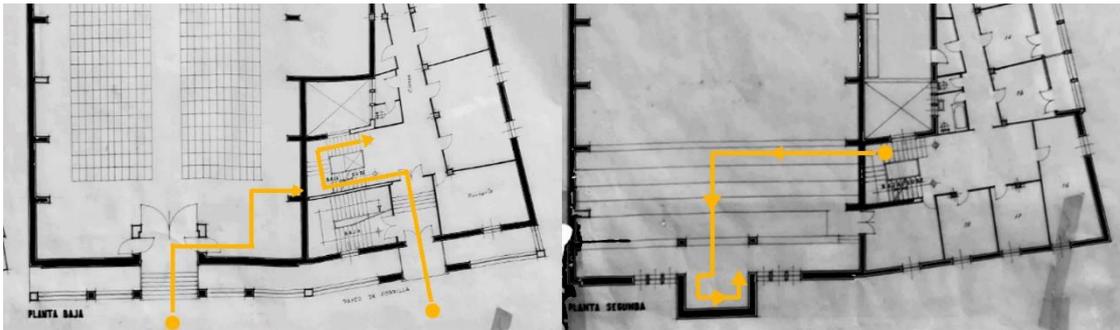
Esquema de acceso y recorridos en planta baja y de coro. Algunos pasos difieren en la realidad con el proyecto original. Fuente: Modificación cromática y foto-montaje de fragmentos de los planos originales de Julio González <https://jgonzalez.archivosarquitectos.com/es/original/project/3> consultado junio de 2022
